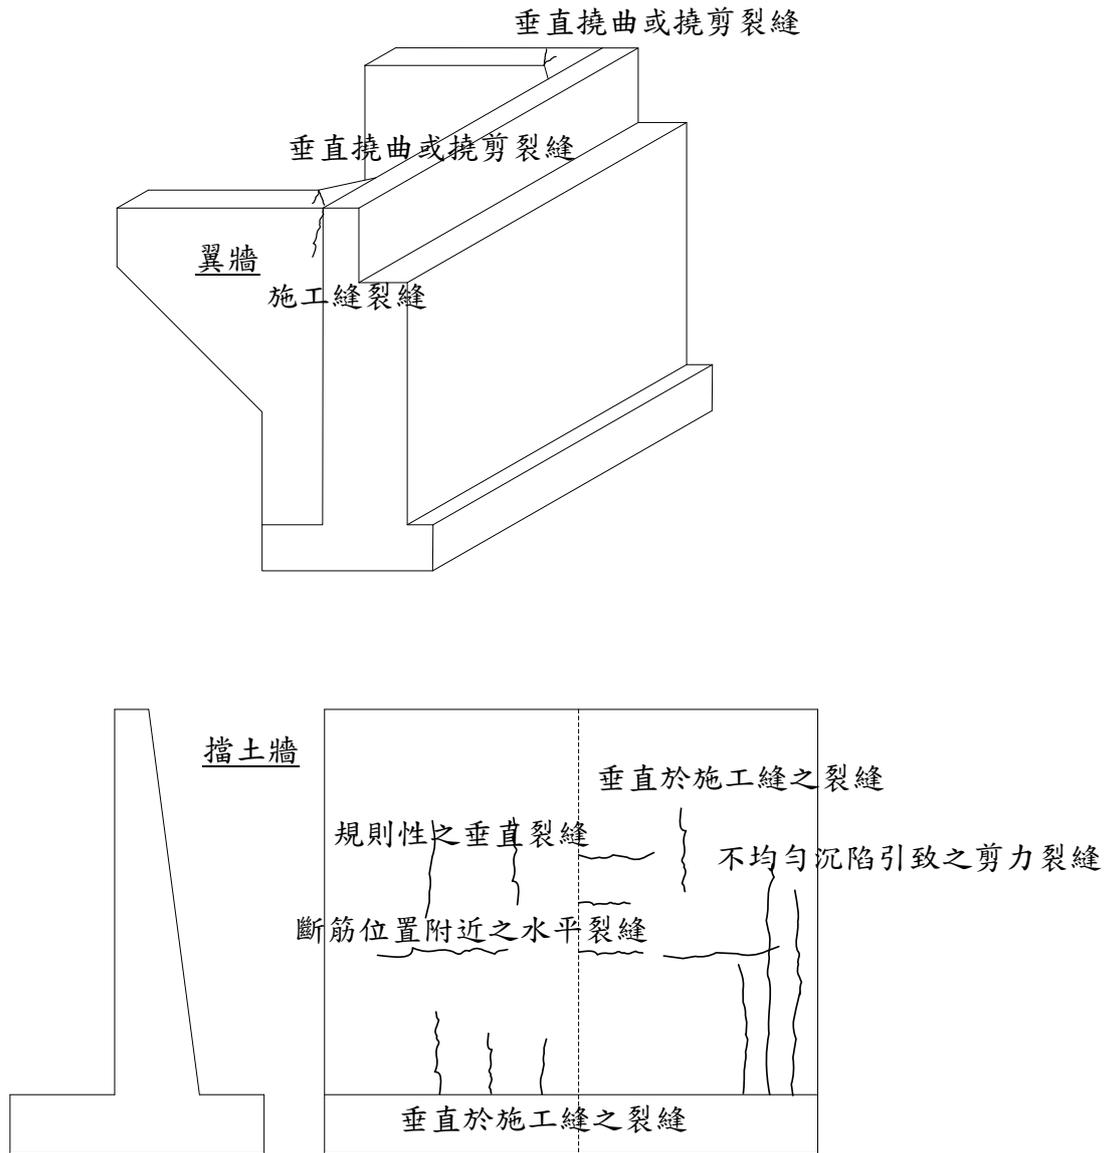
混凝土翼牆/擋土牆裂縫示意圖
